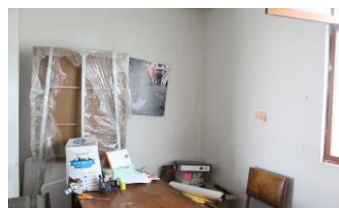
Fisuras en muros – Bloque C CCJ-GBA/
